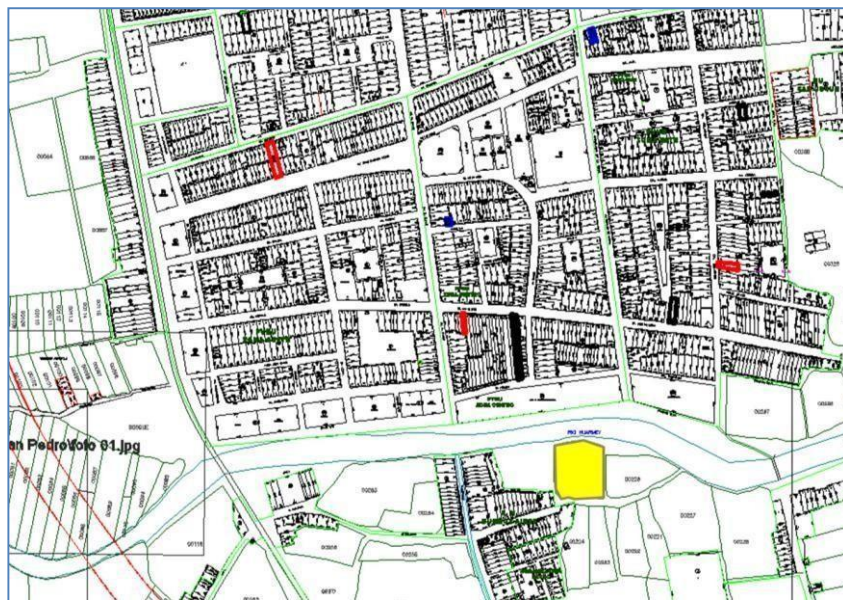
Plano de Ubicación del Proyecto Arquitectónico
